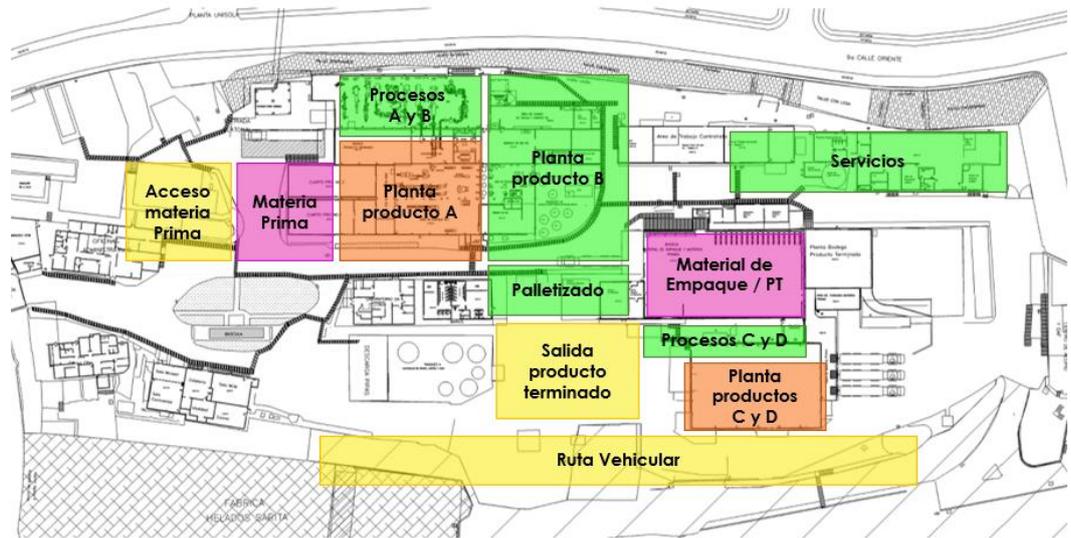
Distribución de locales en el lay-out de Planta El Salvador
